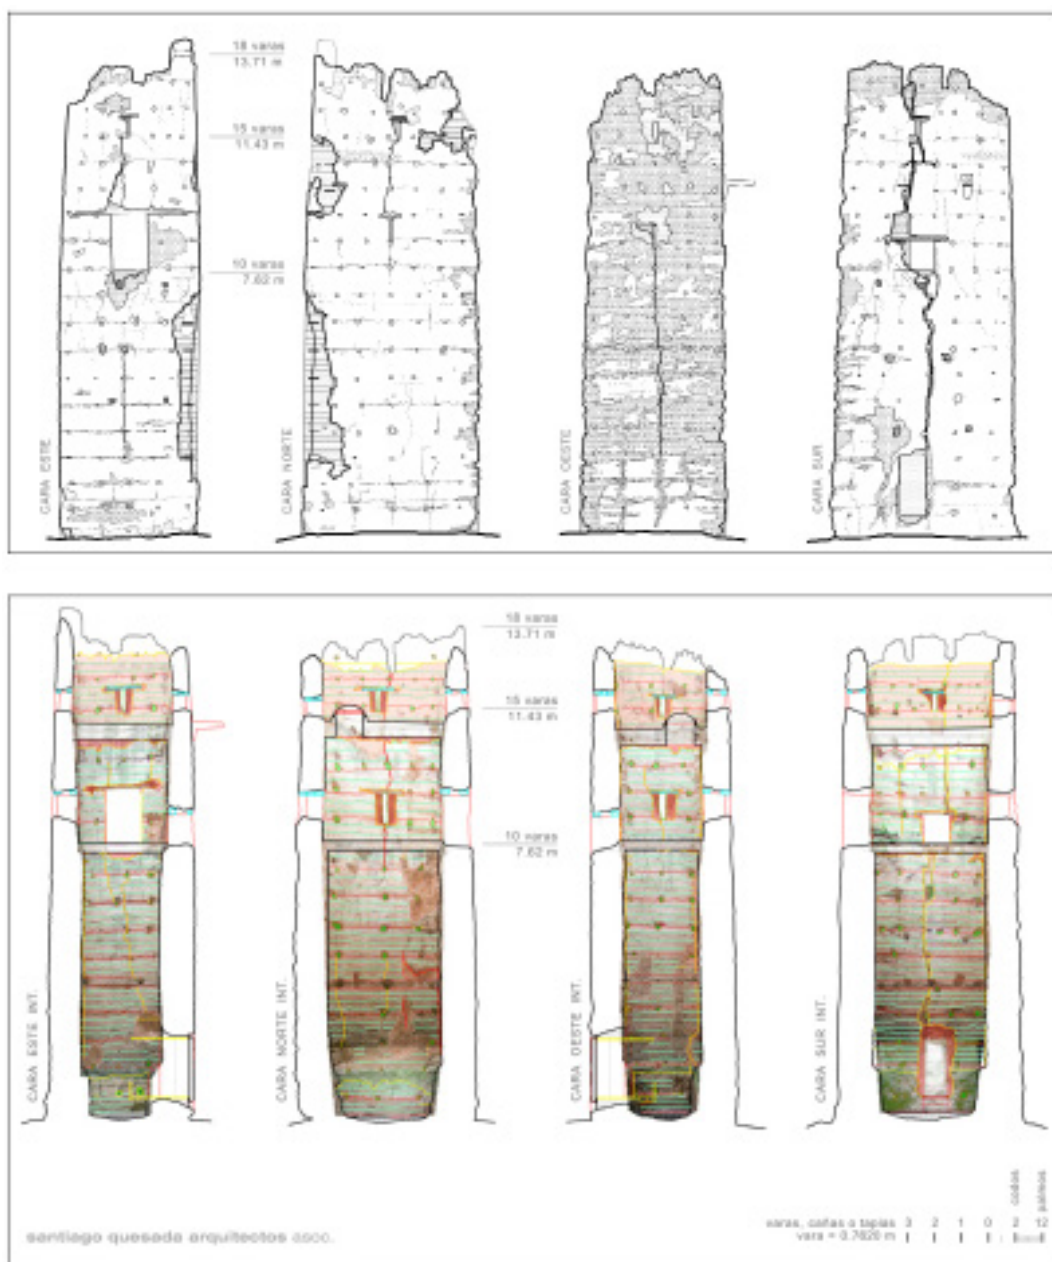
Alzados (arriba) y secciones (abajo) actuales de la torre Norte de Santa Catalina, con la propuesta de intervención.
